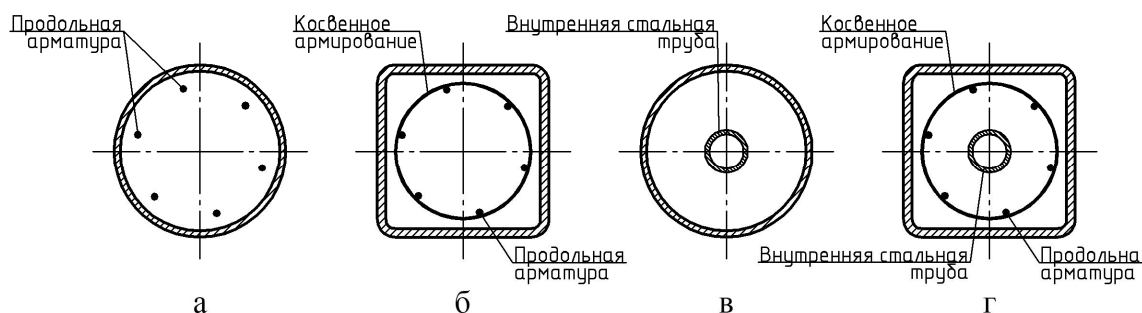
Варианты армирования бетонного ядра трубобетонных колонн
